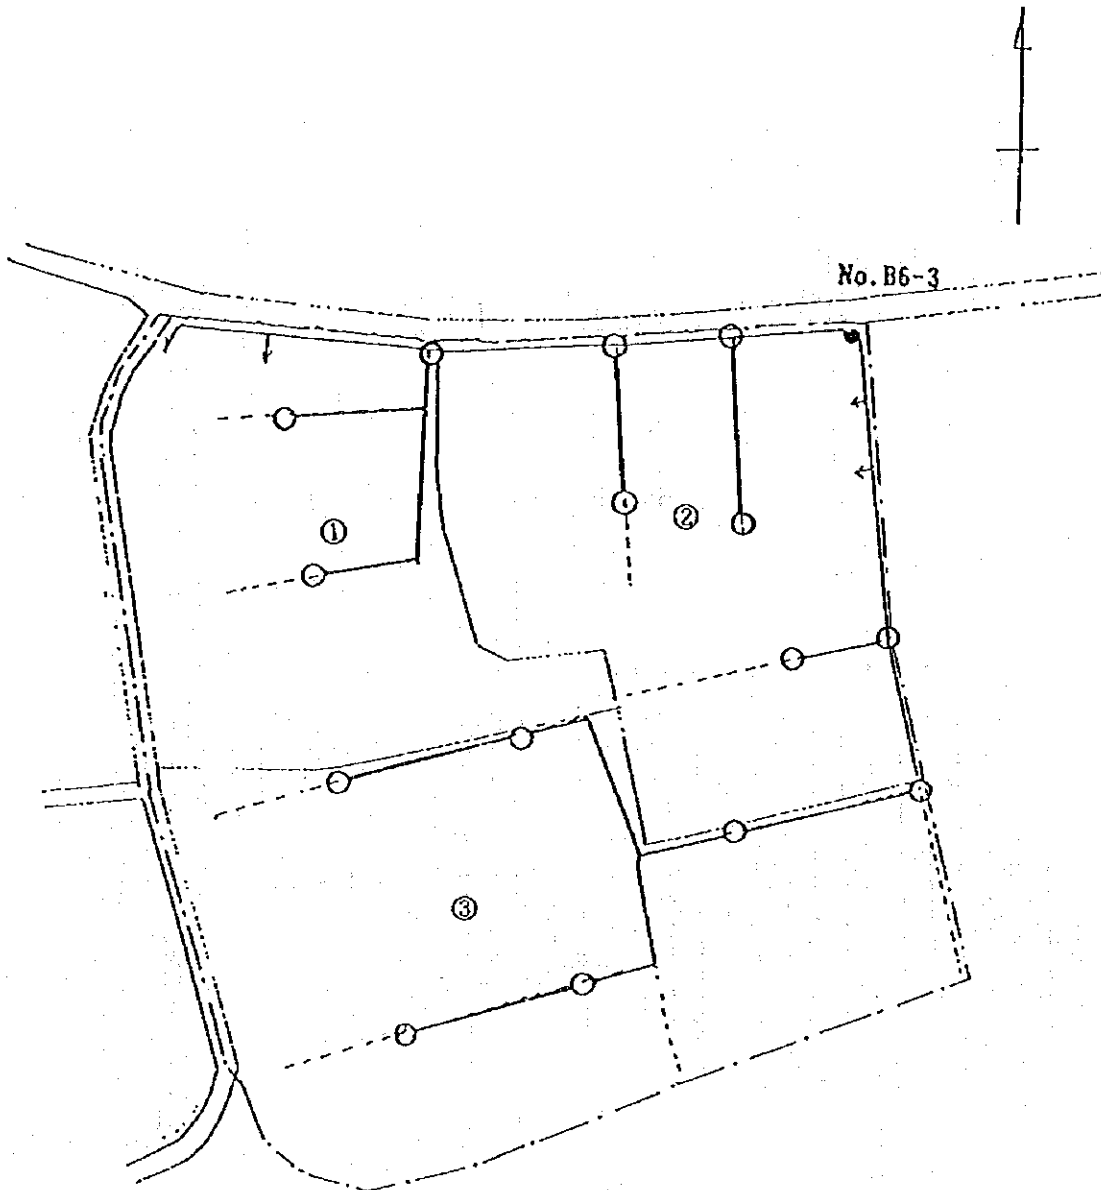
Plan horizontal du projet des installations terminales (Oued Shili)
